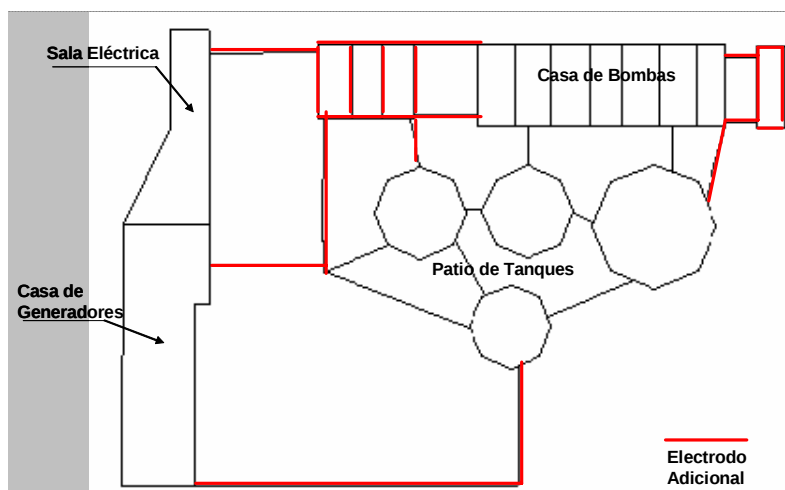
Sistema Integral de Tierra de la Planta – Configuración Final.
